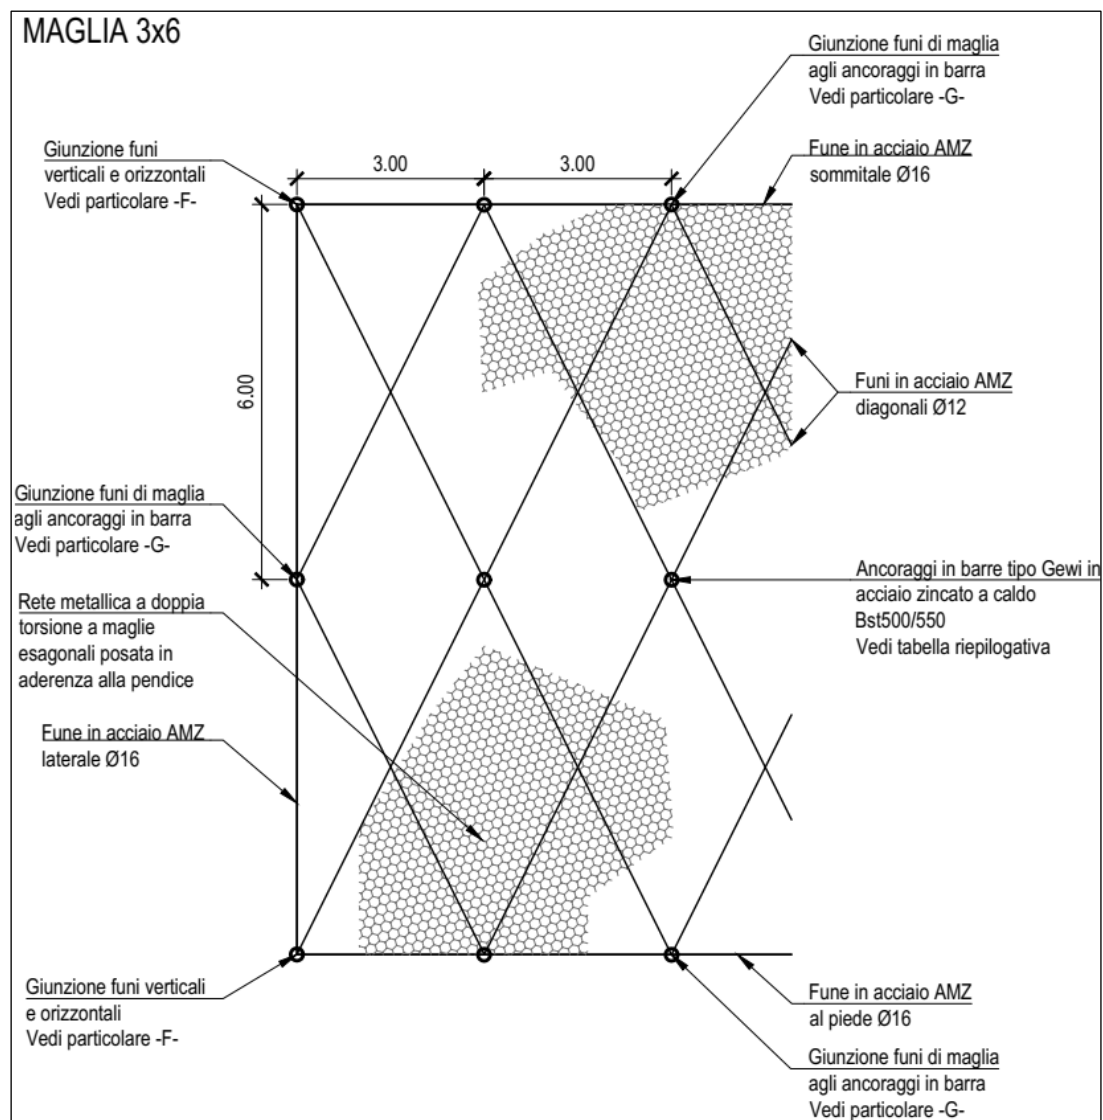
Prospetto tipologico del rafforzamento corticale con maglia di ancoraggi rettangolare 3x6 m
